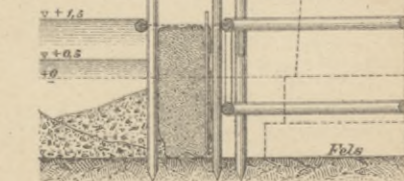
Umschliessung des Betonbettes mit Fangdämmen.
